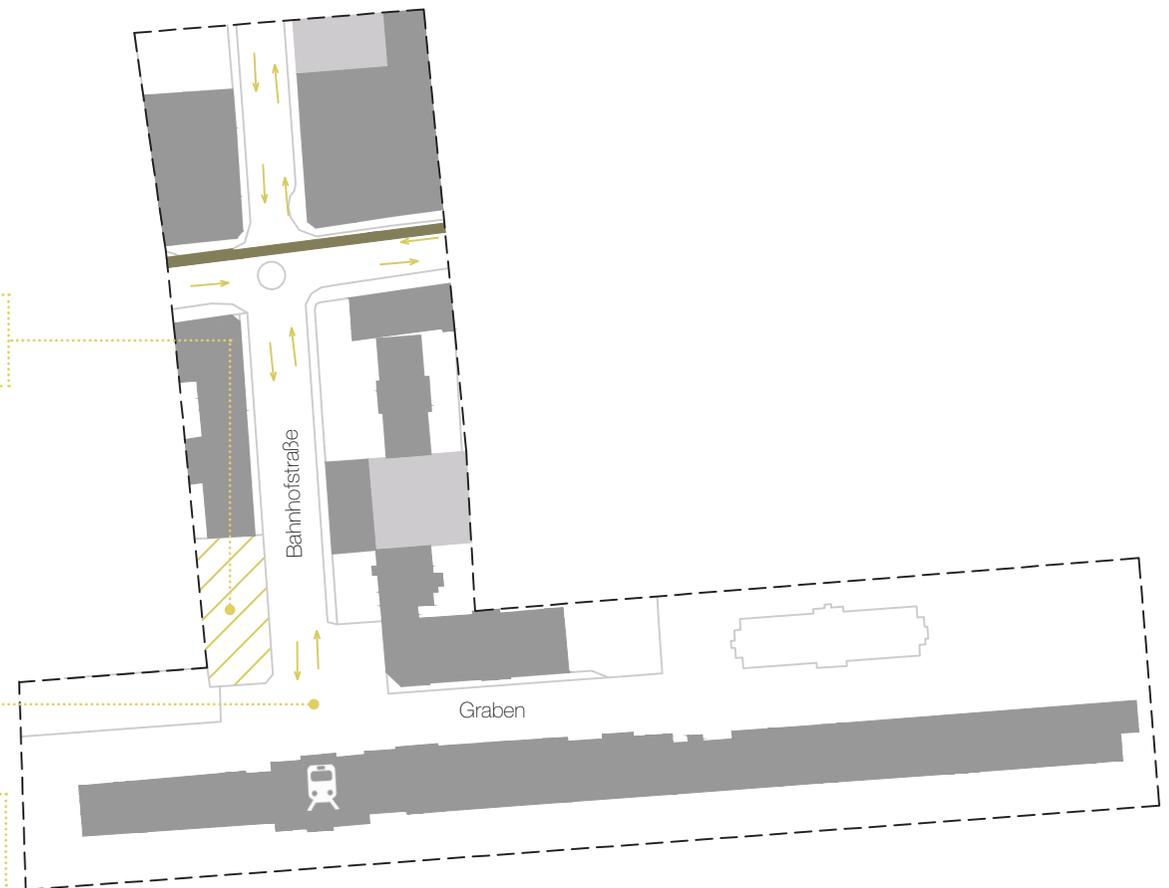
Verkehrsraum und Freiflächen: Bahnhofstraße
